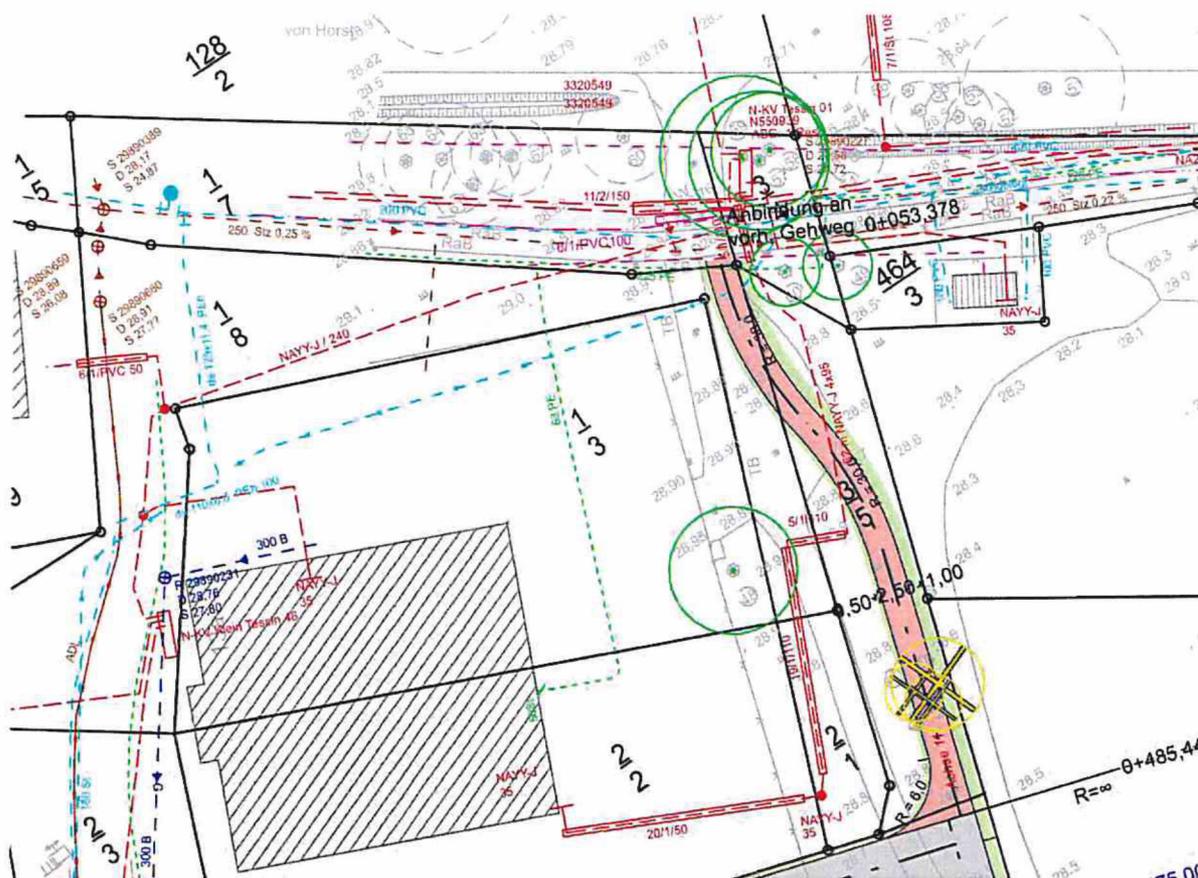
Geplante Gestaltung des Fuß-/Radweges im Nordwesten des Plangebietes (rote Fläche) (VEAPLAN ROSTOCK GBR 2019)
